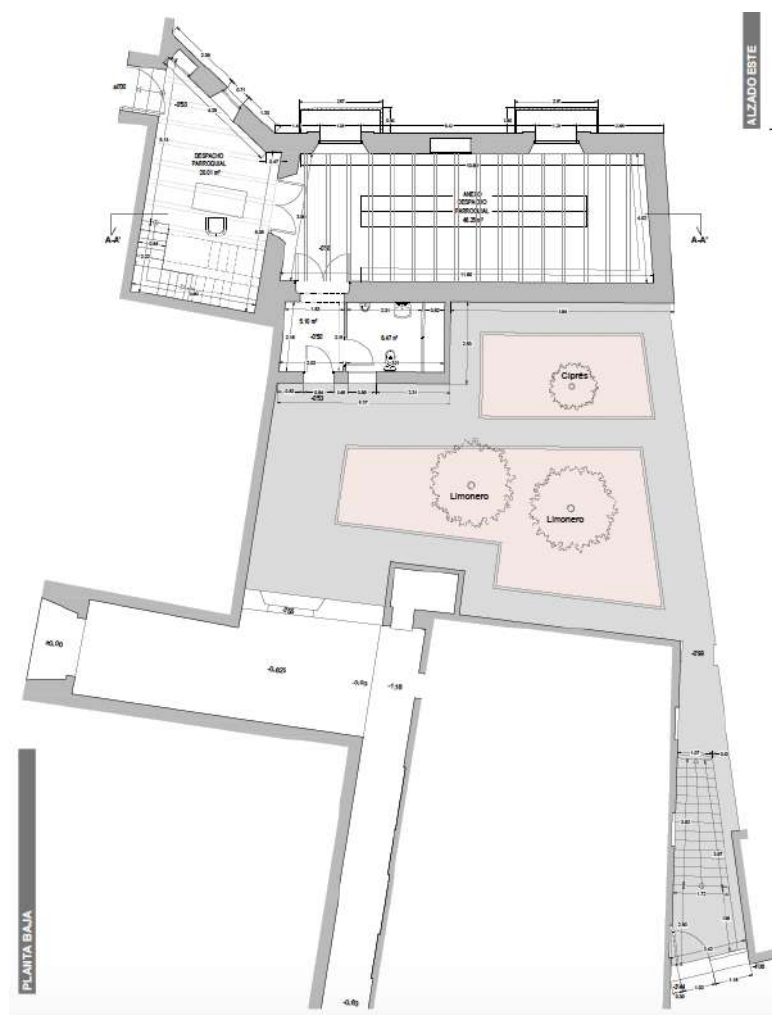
Planta de la zona de intervención para despacho parroquial y archivo. (Fuente: M^a Auxiliadora Portero).
